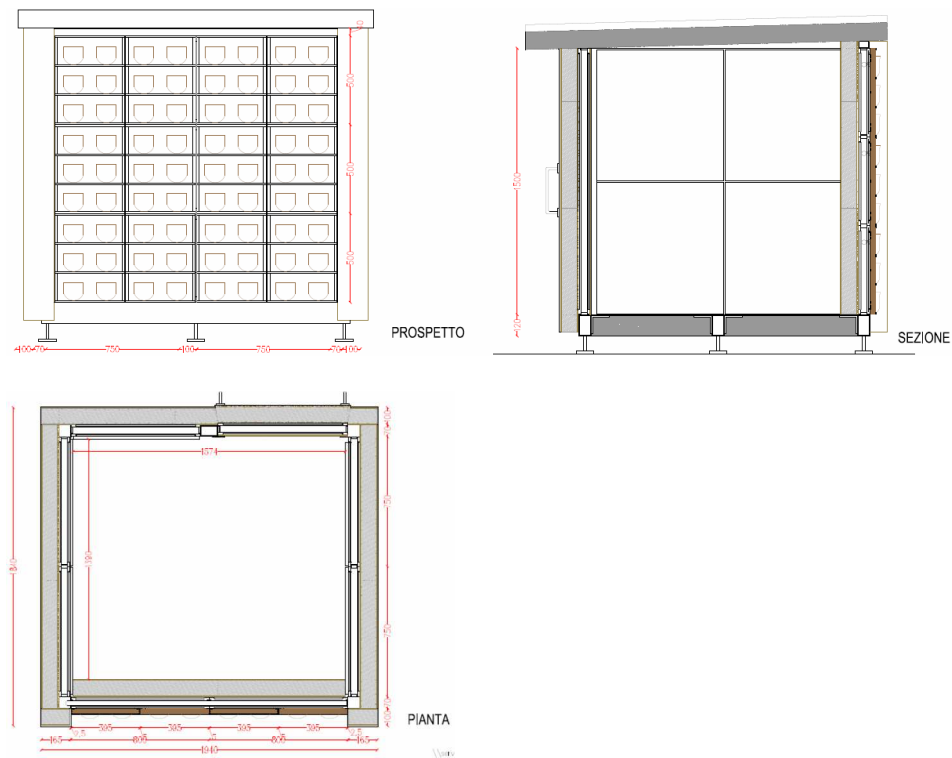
Prospetto, sezione e pianta del dimostratore.
